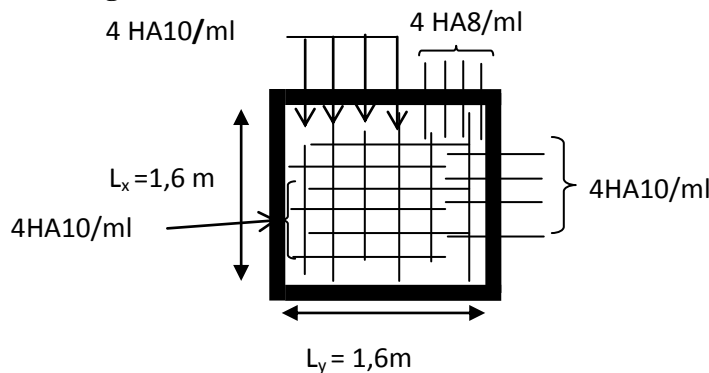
Schéma de ferrailage de la dalle du local machine
